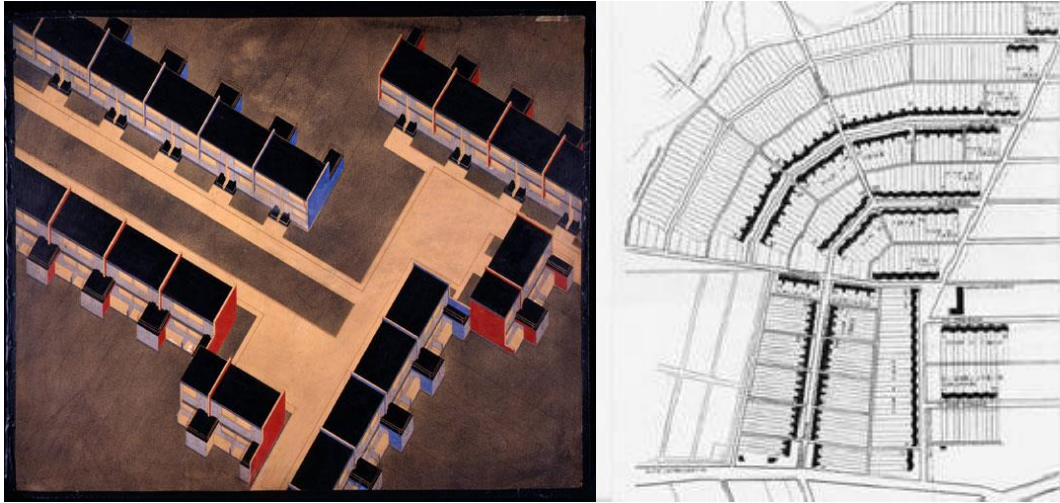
axonometria e planta de implantação do complexo *Siedlung Torten*, Dessau, 1926/27, Walter Gropius.
